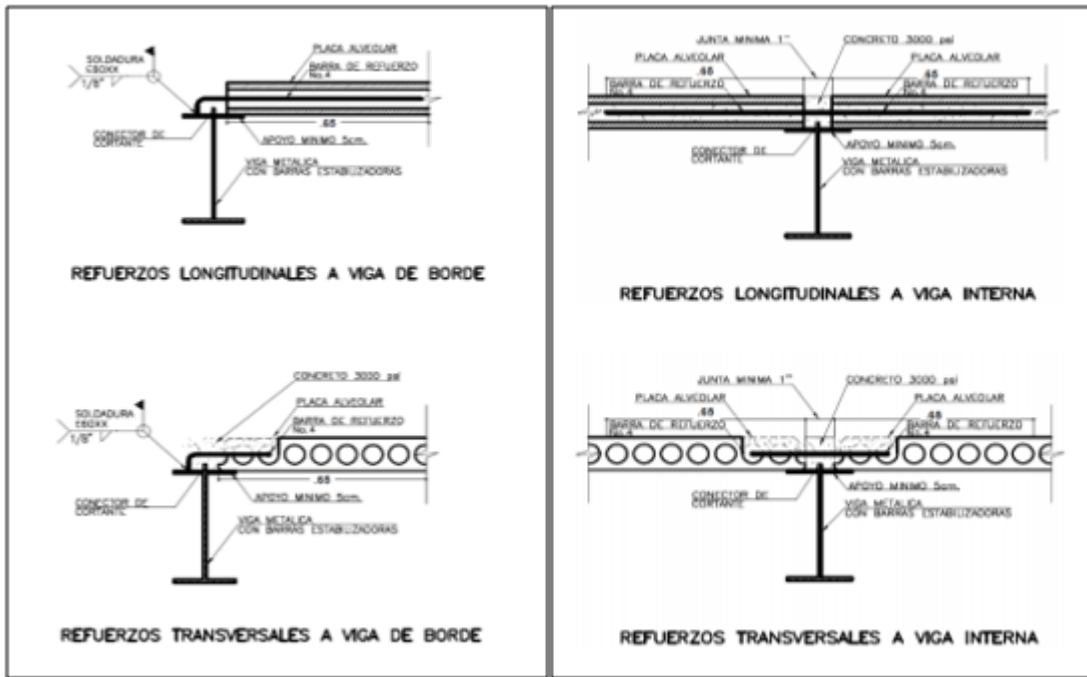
Detalles constructivos viga IPE con Placa Alveolar. (2020)
